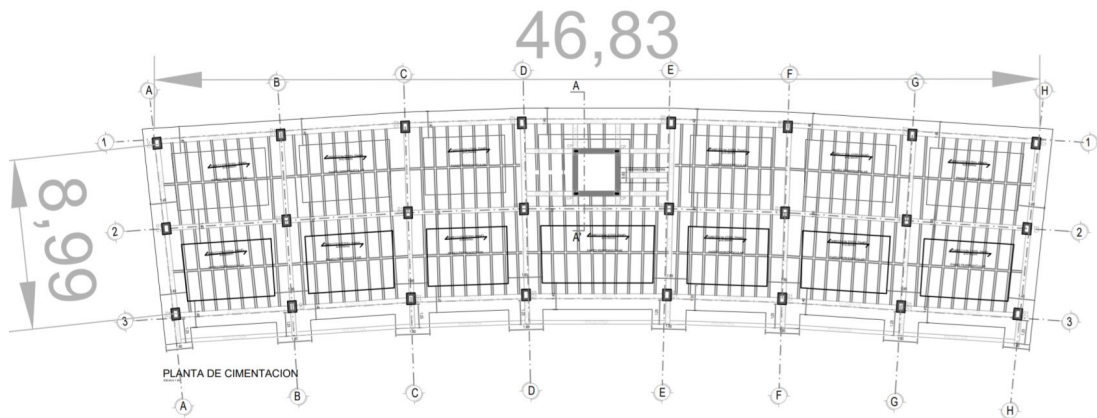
Planta de cimentación con paredes de bloques y vacíos obra OM Center.
